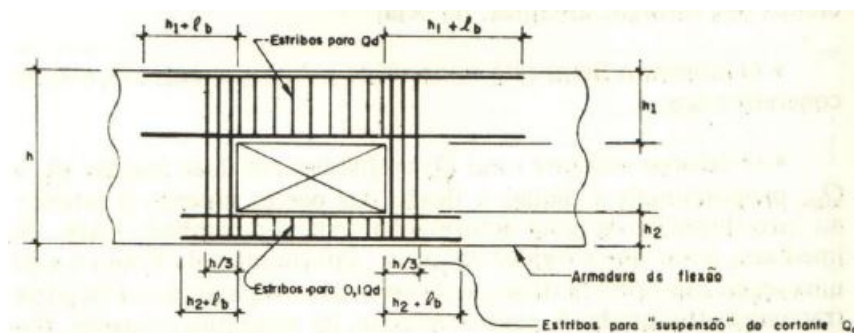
Detalhamento das armaduras de reforço em abertura, segundo Sussekind
